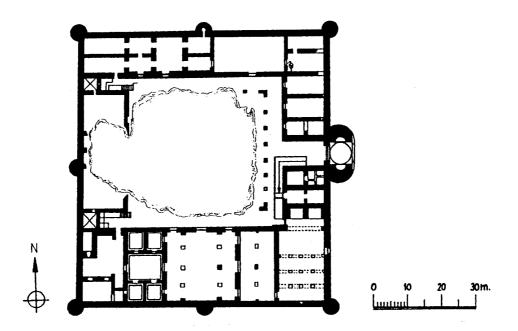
مسقط أفقي للبيمارستان القيمري في دمشق (عن: الريحاوي).
